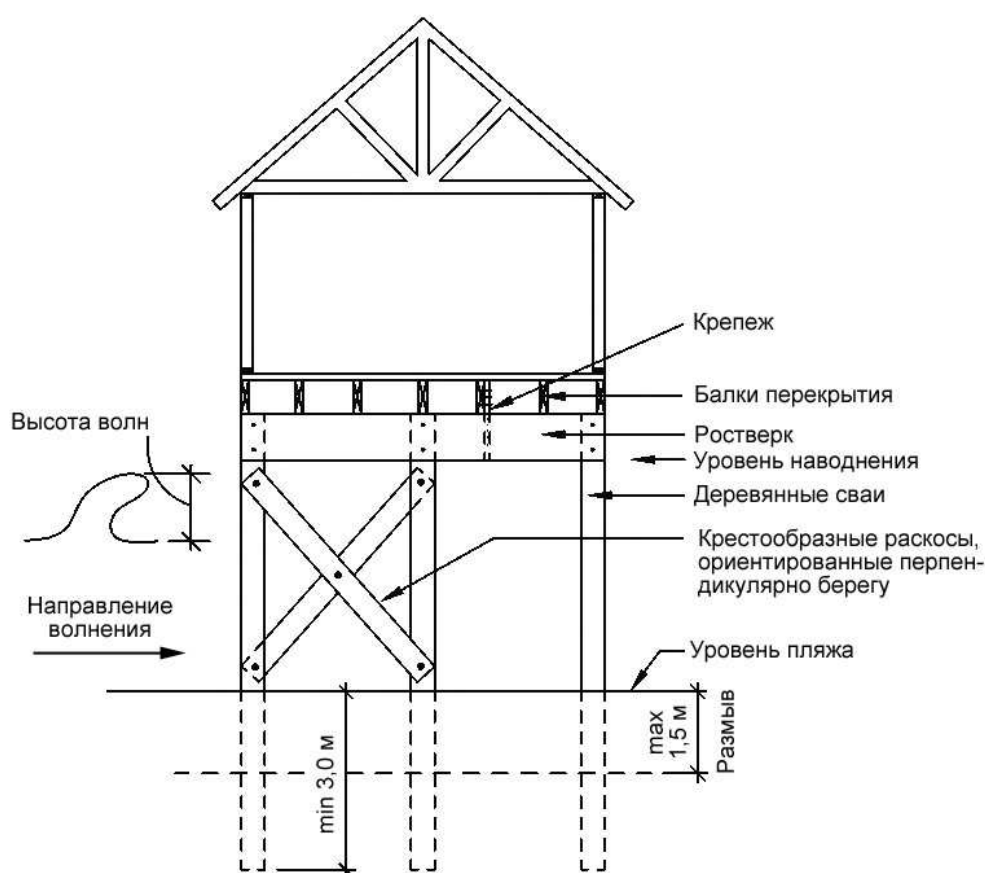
Схема фундамента дома, расположенного в прибрежной зоне
